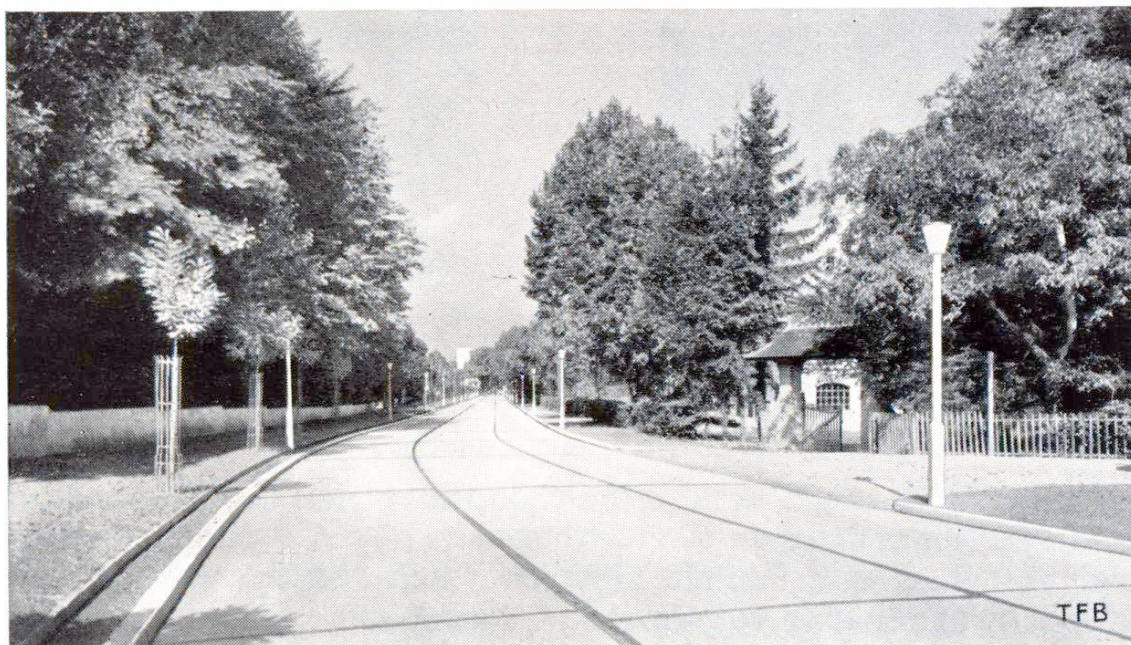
Eine mustergültige Strasse: L'avenue des Bains in Yverdon - Betonbelag, beidseitig Cementrandsteine und Beleuchtungsposten aus Kunststein.
